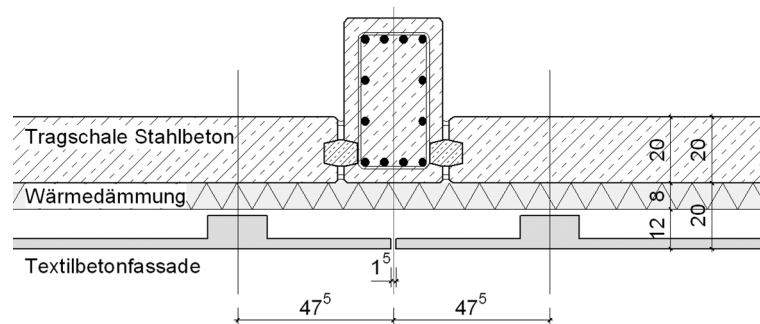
Horizontalschnitt: Bezug Fassade – Tragwerk
